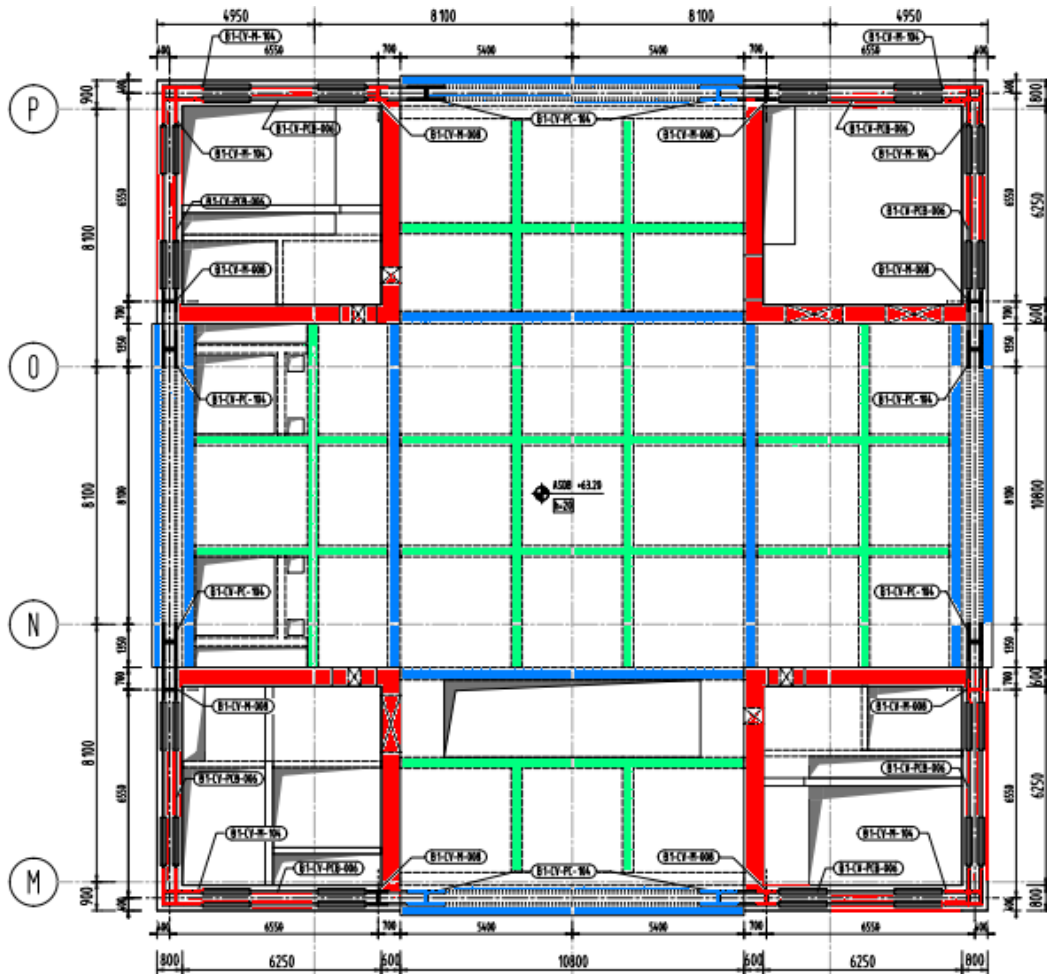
Vue en plan du plancher, Niveau 63,20 m.
